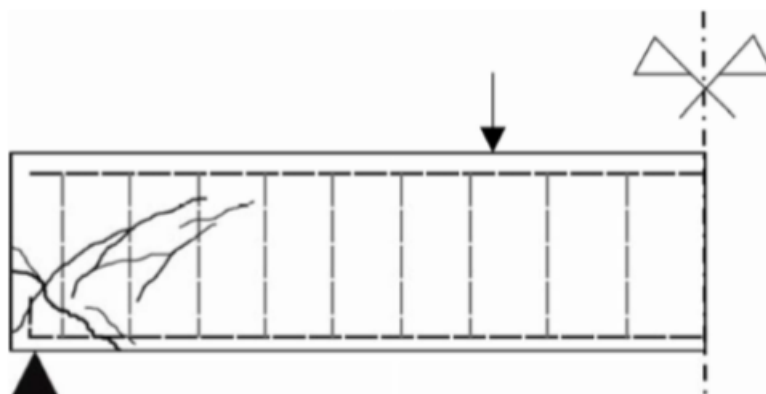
Ruptura por falha de ancoragem no apoio (Barros, 2009)
